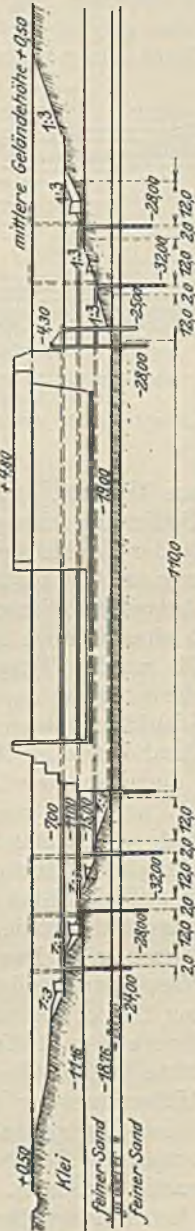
b. Grundwasserabsenkungsanlage beim Bau der Emler Seeschleuse. Mehrere Staffeln.
